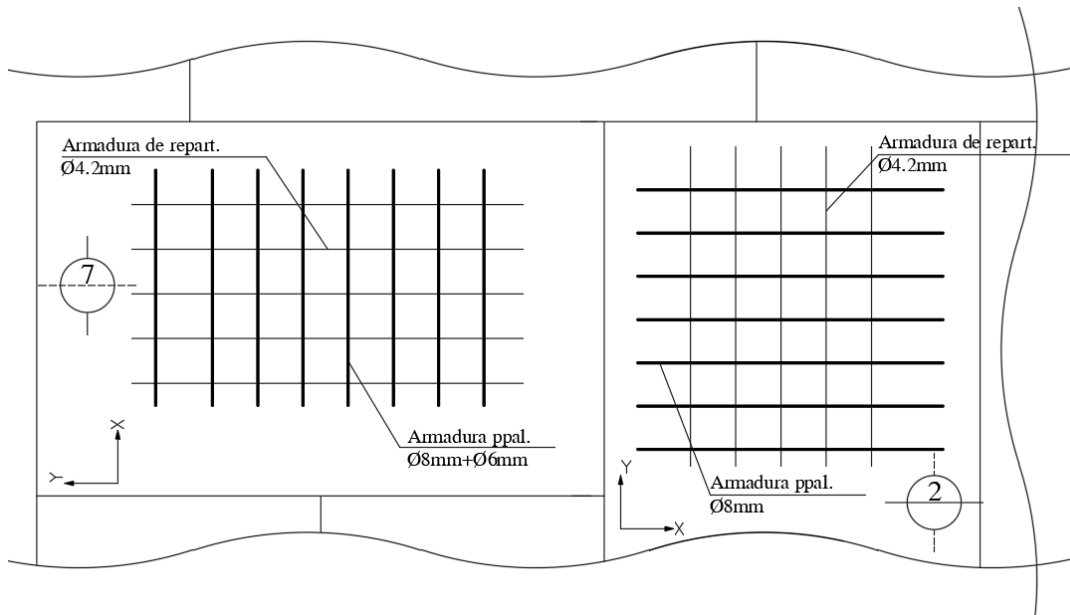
Esquema de posición de armaduras según planilla para Losas L2 y L7.
